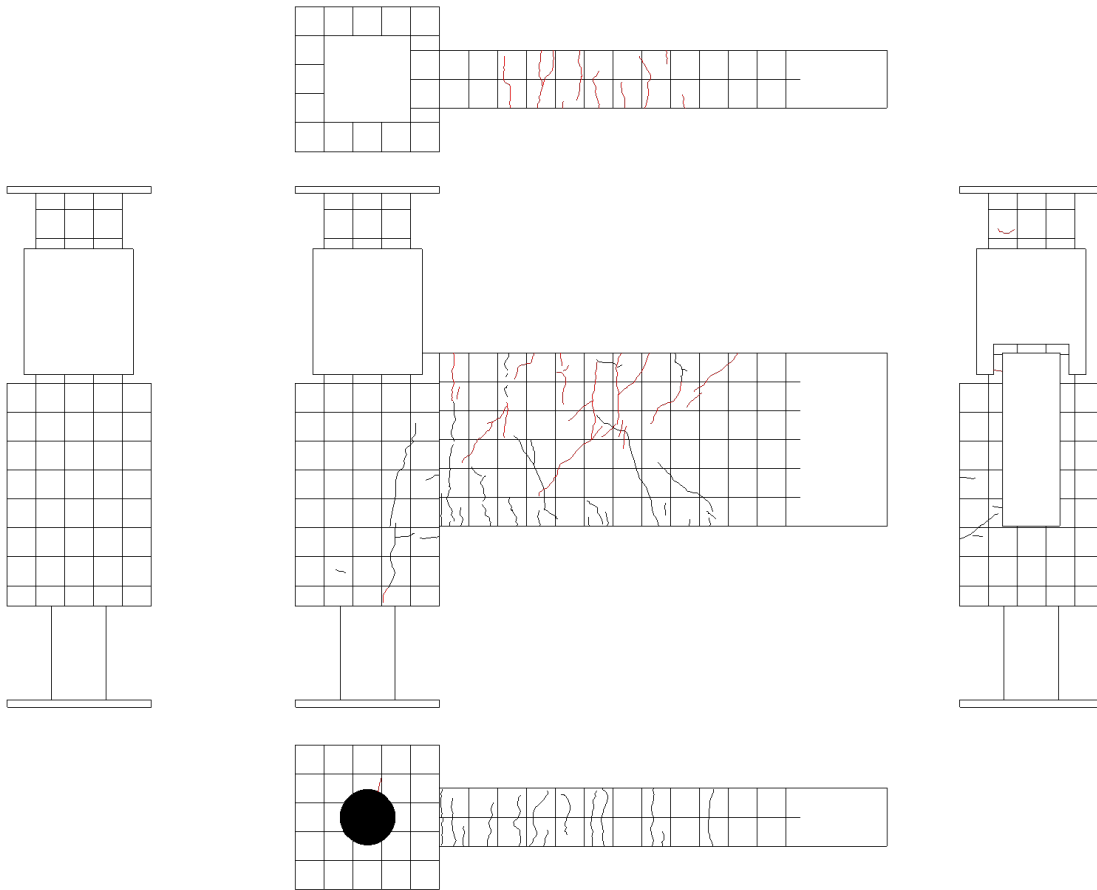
3. 45 試験体 A-1 ひび割れ状況 (2Cycle)
